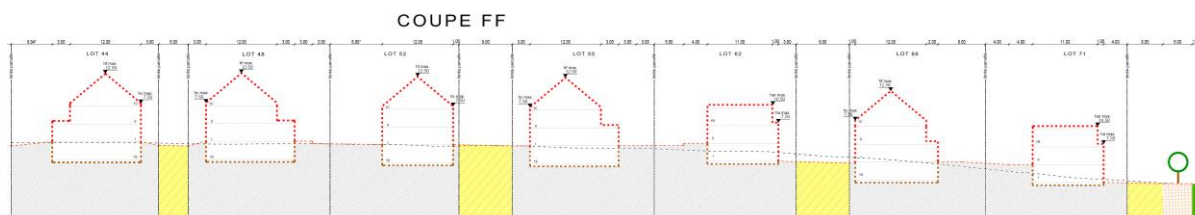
Coupe longitudinale – Implantation des maisons dans la topographie du terrain (Source : BEST)
